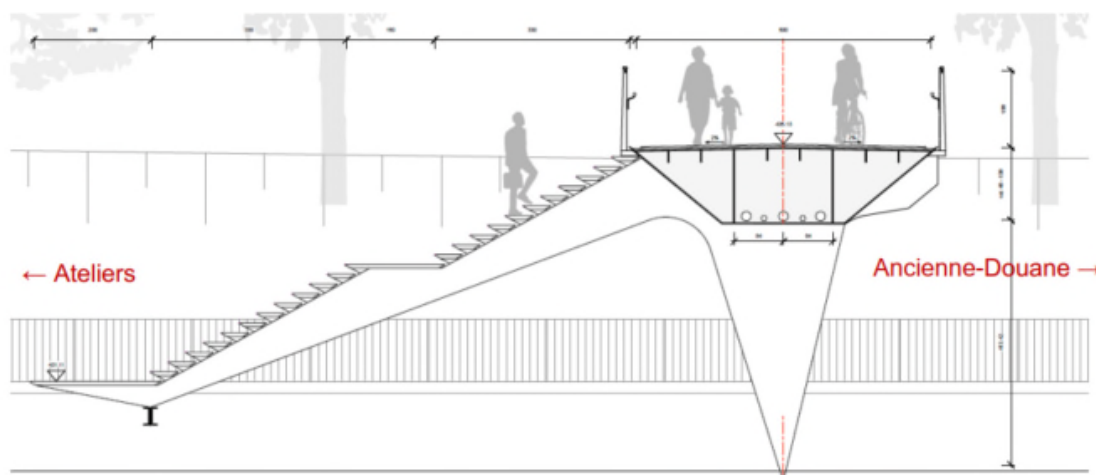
Coupe transversale de l'ouvrage au droit de la pile
